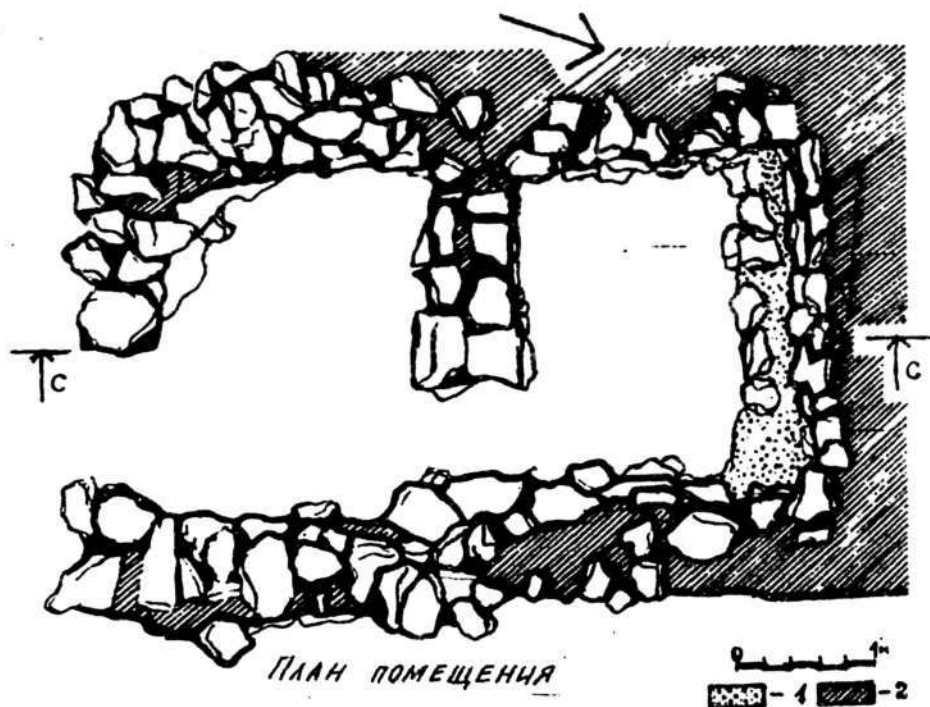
Поселение Харкуш. План помещения № 1 третьего хозяйственно-жилого комплекса: 1 — пристенная полочка, 2 — грунтослой кладки стен помещения.
